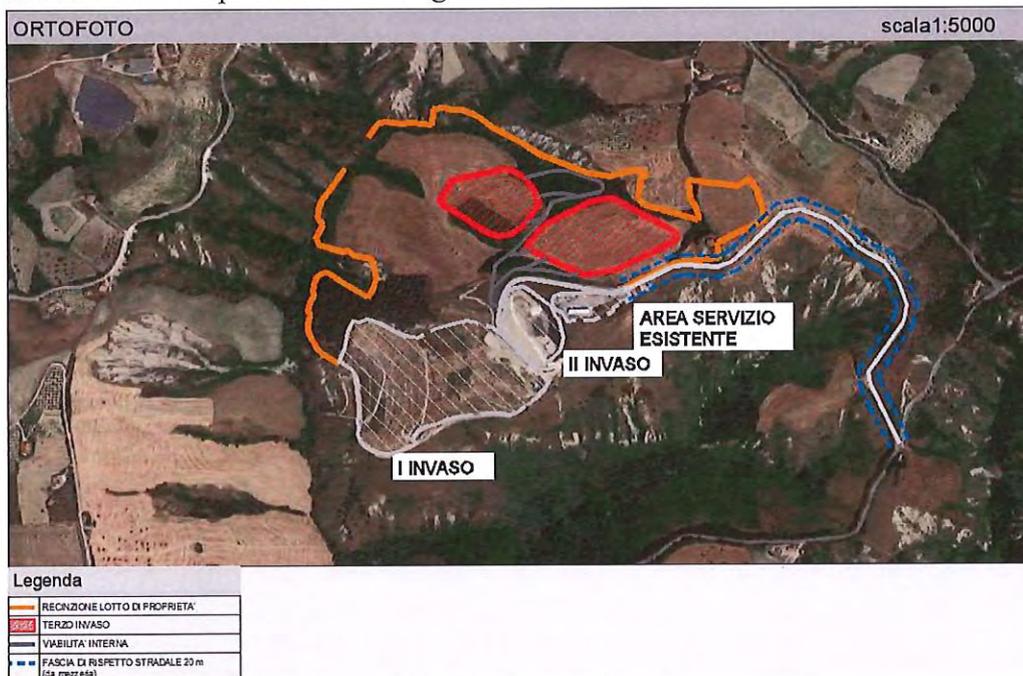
Stralcio planimetrico con fascia di rispetto dalla strada comunale
